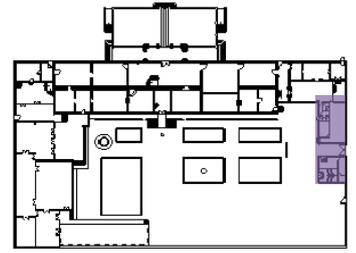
Fungsi ruang pada denah lantai 1-a Museum Fatahillah
